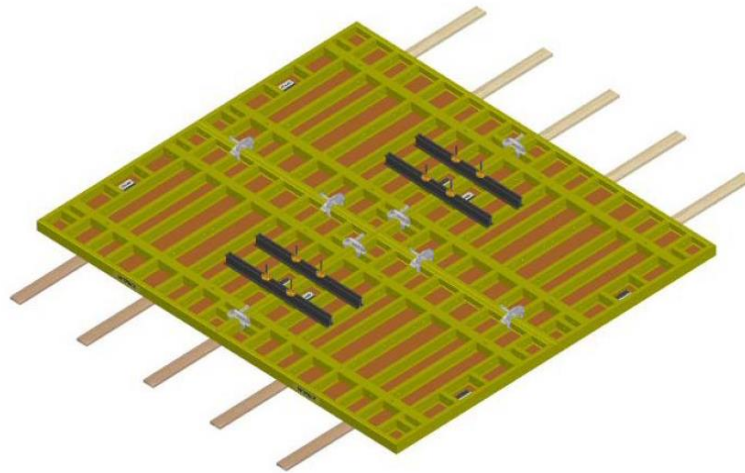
b. Configuración terminada de la formación de un panel. Recuperado de: Ulma Construction, *Instrucción técnica de montaje.
